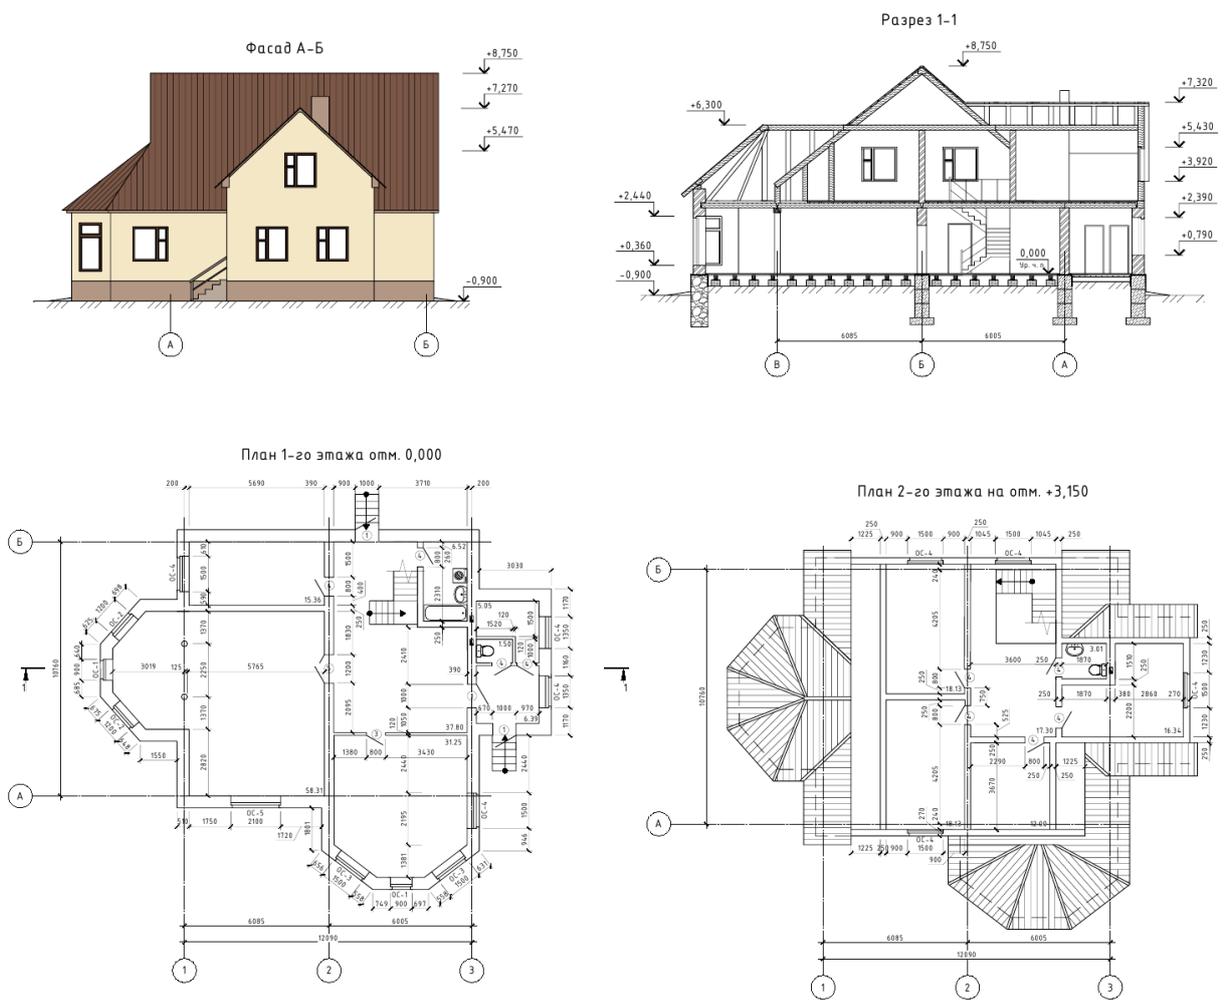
Пример компоновки фасада, планов и разреза малоэтажного жилого дома
